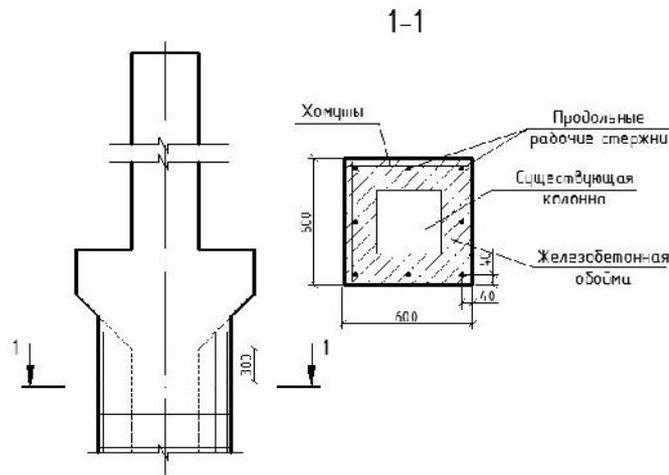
Усиление железобетонной колонны железобетонной обоймой
